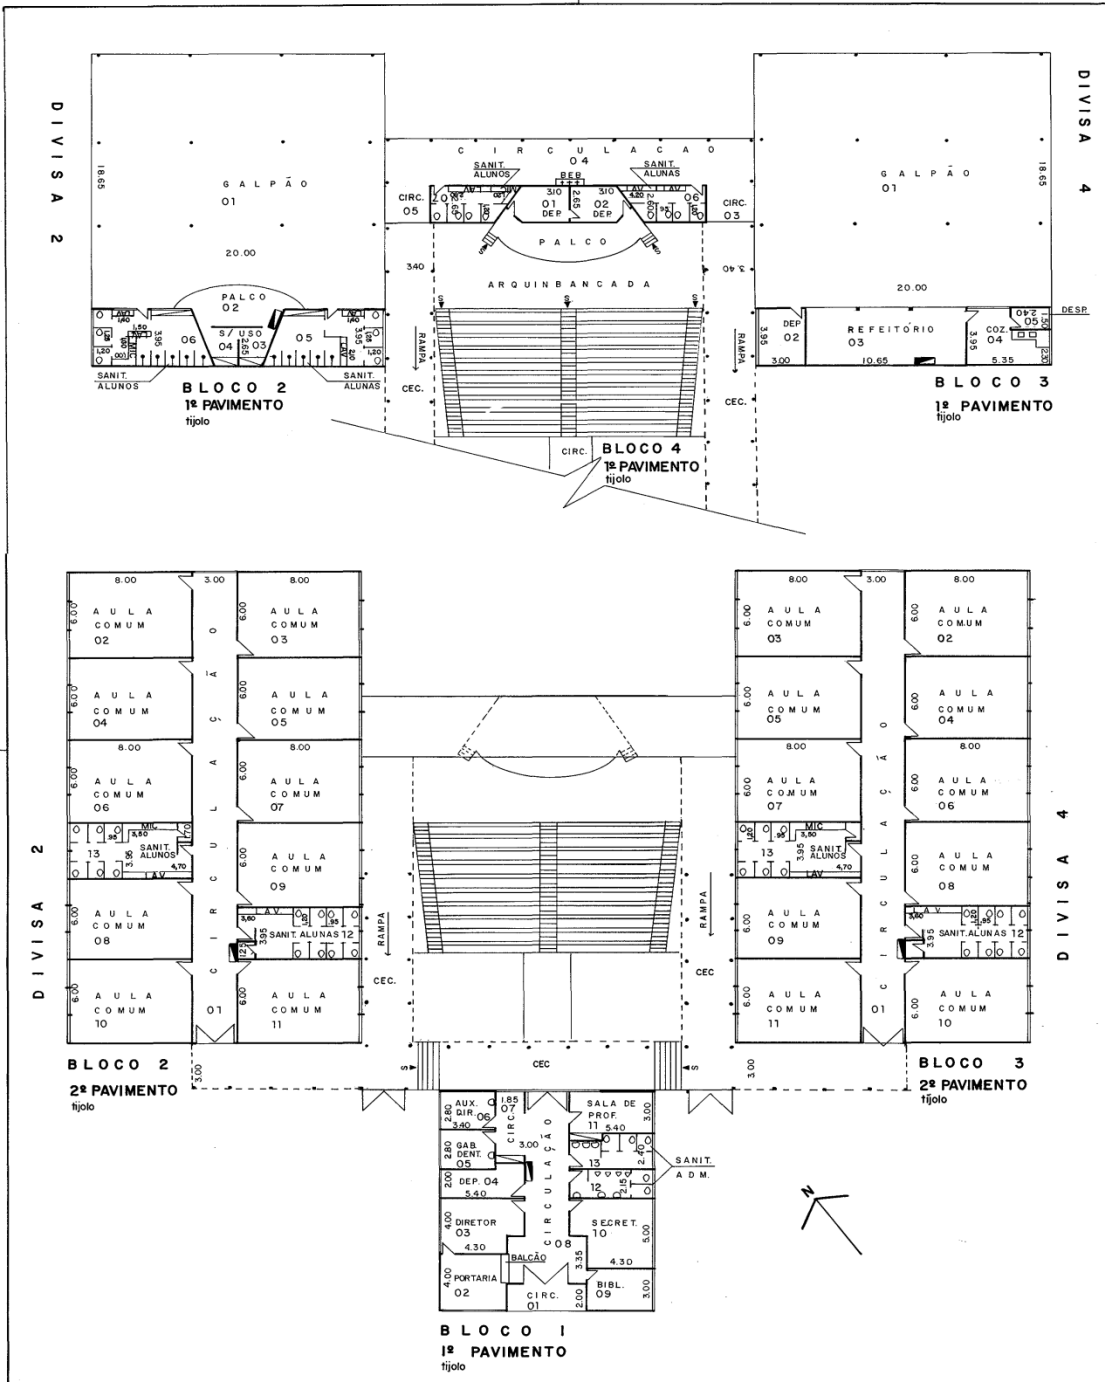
Planta baixa do Grupo Escolar da Vila Castelo Branco.
